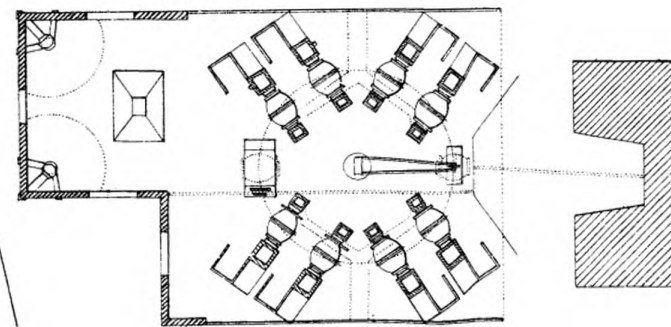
Plan de la halle de puddlage mécanique (8 fours.)
